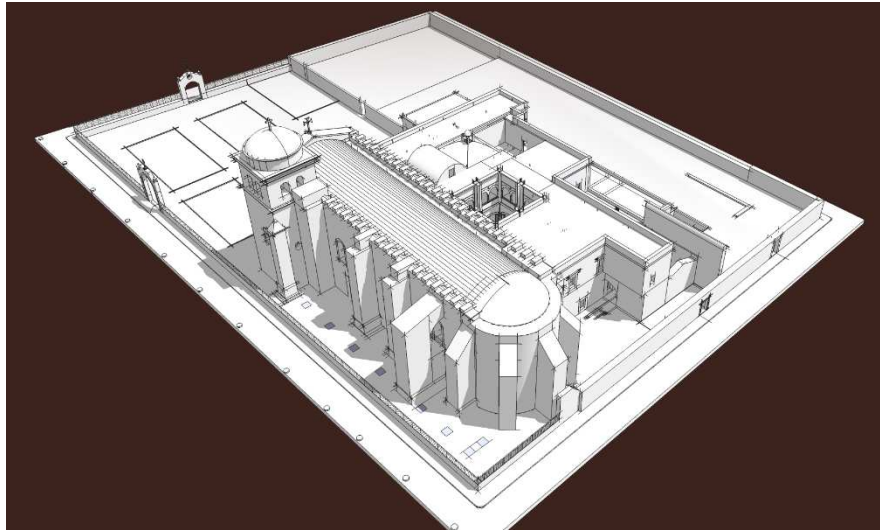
Maqueta del edificio. Fachada posterior, nave y convento. (Fuente: García, 2009)
